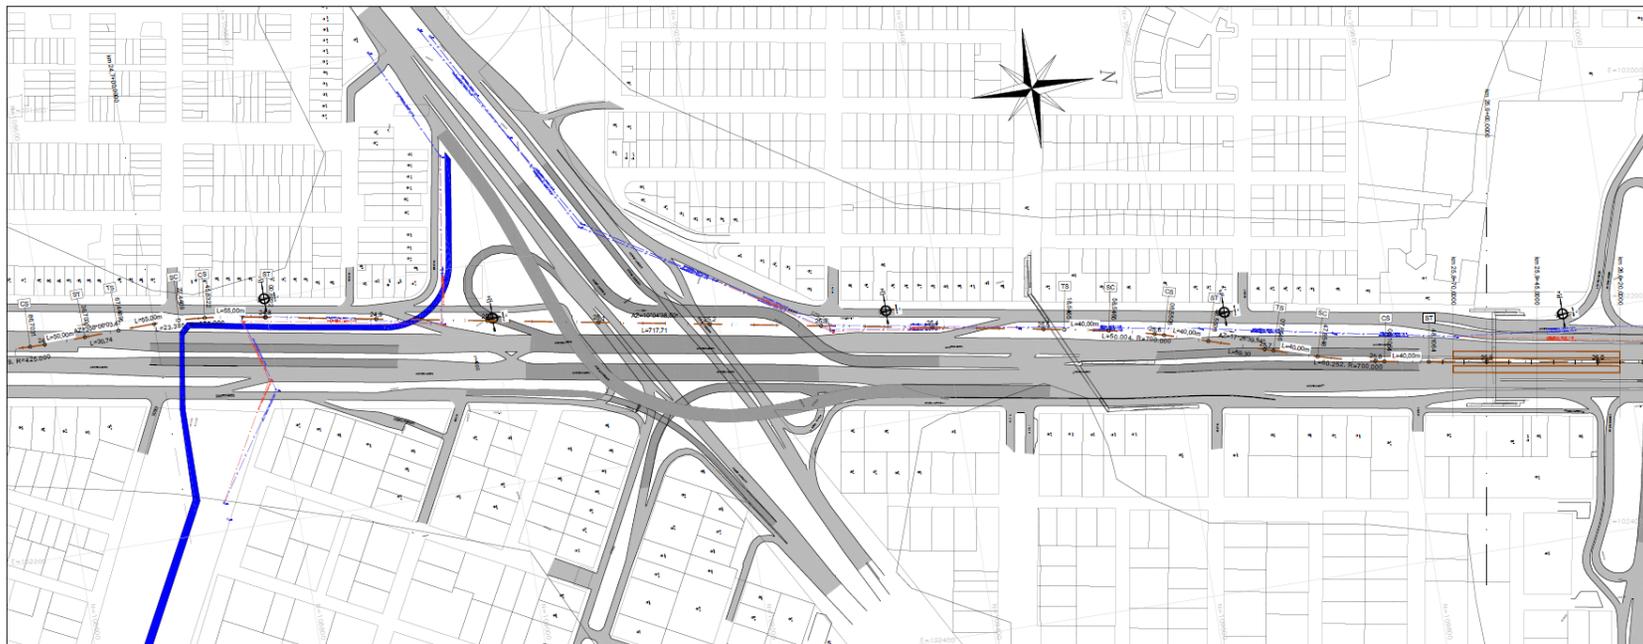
Vista en planta Alternativa 4, Tramo calle 72-calle 90
